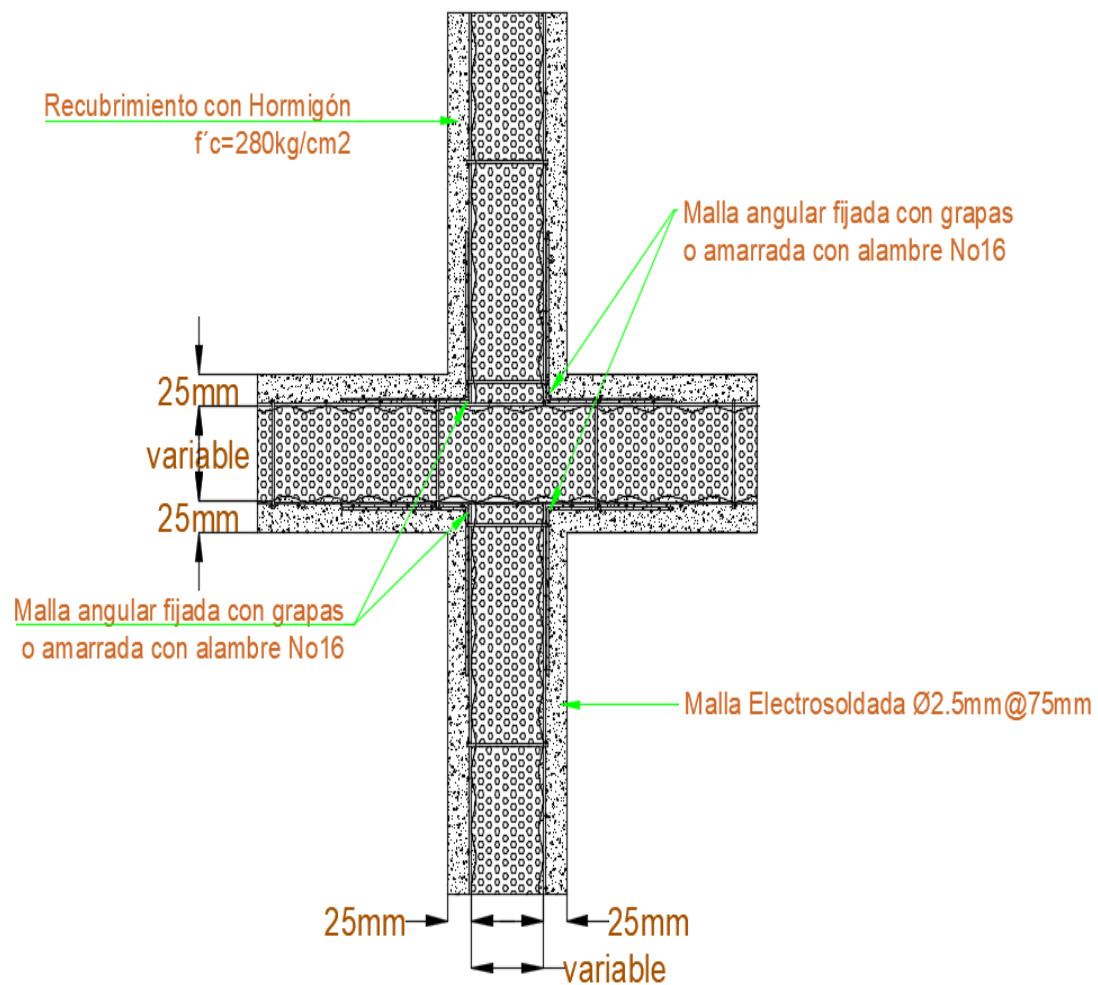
Detalle unión de paneles en cruz (PLANTA)
